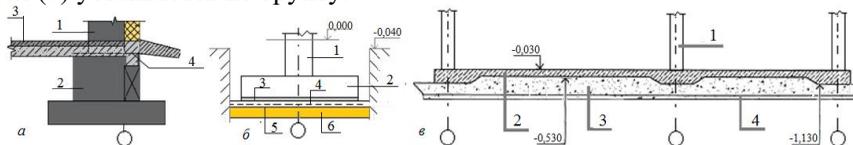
Конструктивные решения фундаментов для одноэтажного каркасного здания: *а* – отдельный столбчатый фундамент (сборный или монолитный), *б* – сборный элемент колонна-фундамент, в – монолитный плитный фундамент с уширениями в местах расположения колонн
